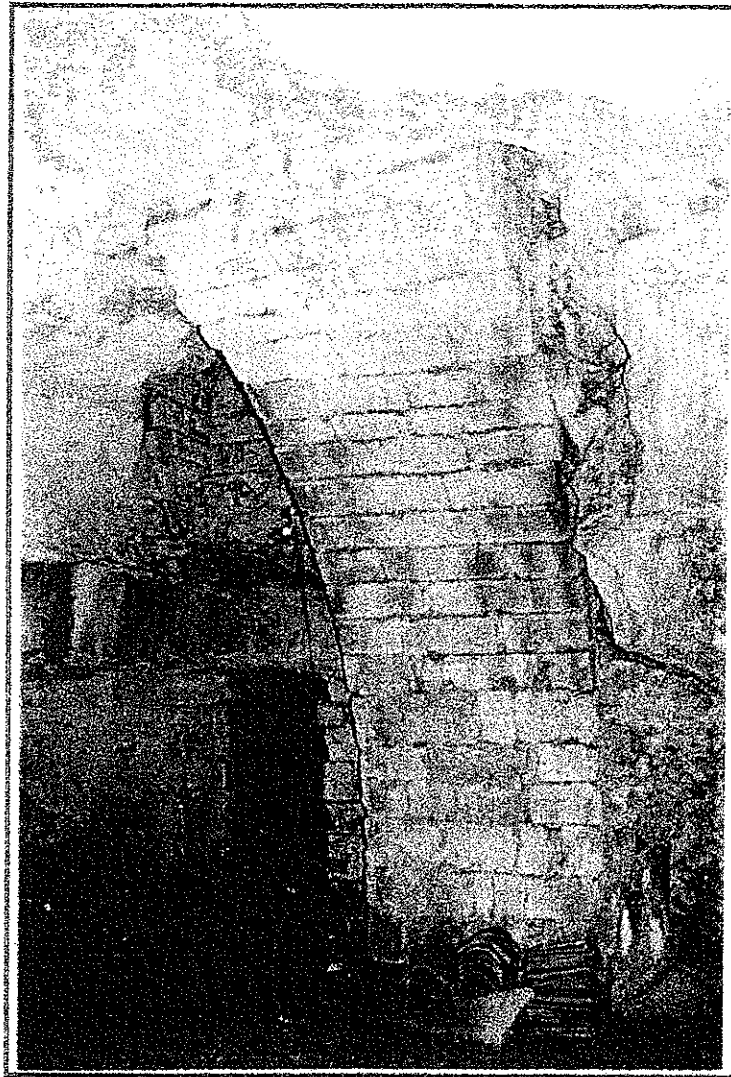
Exemple de premier niveau de carrière avec renforcement par voûte en pierres de taille servant d'assise à un escalier.
